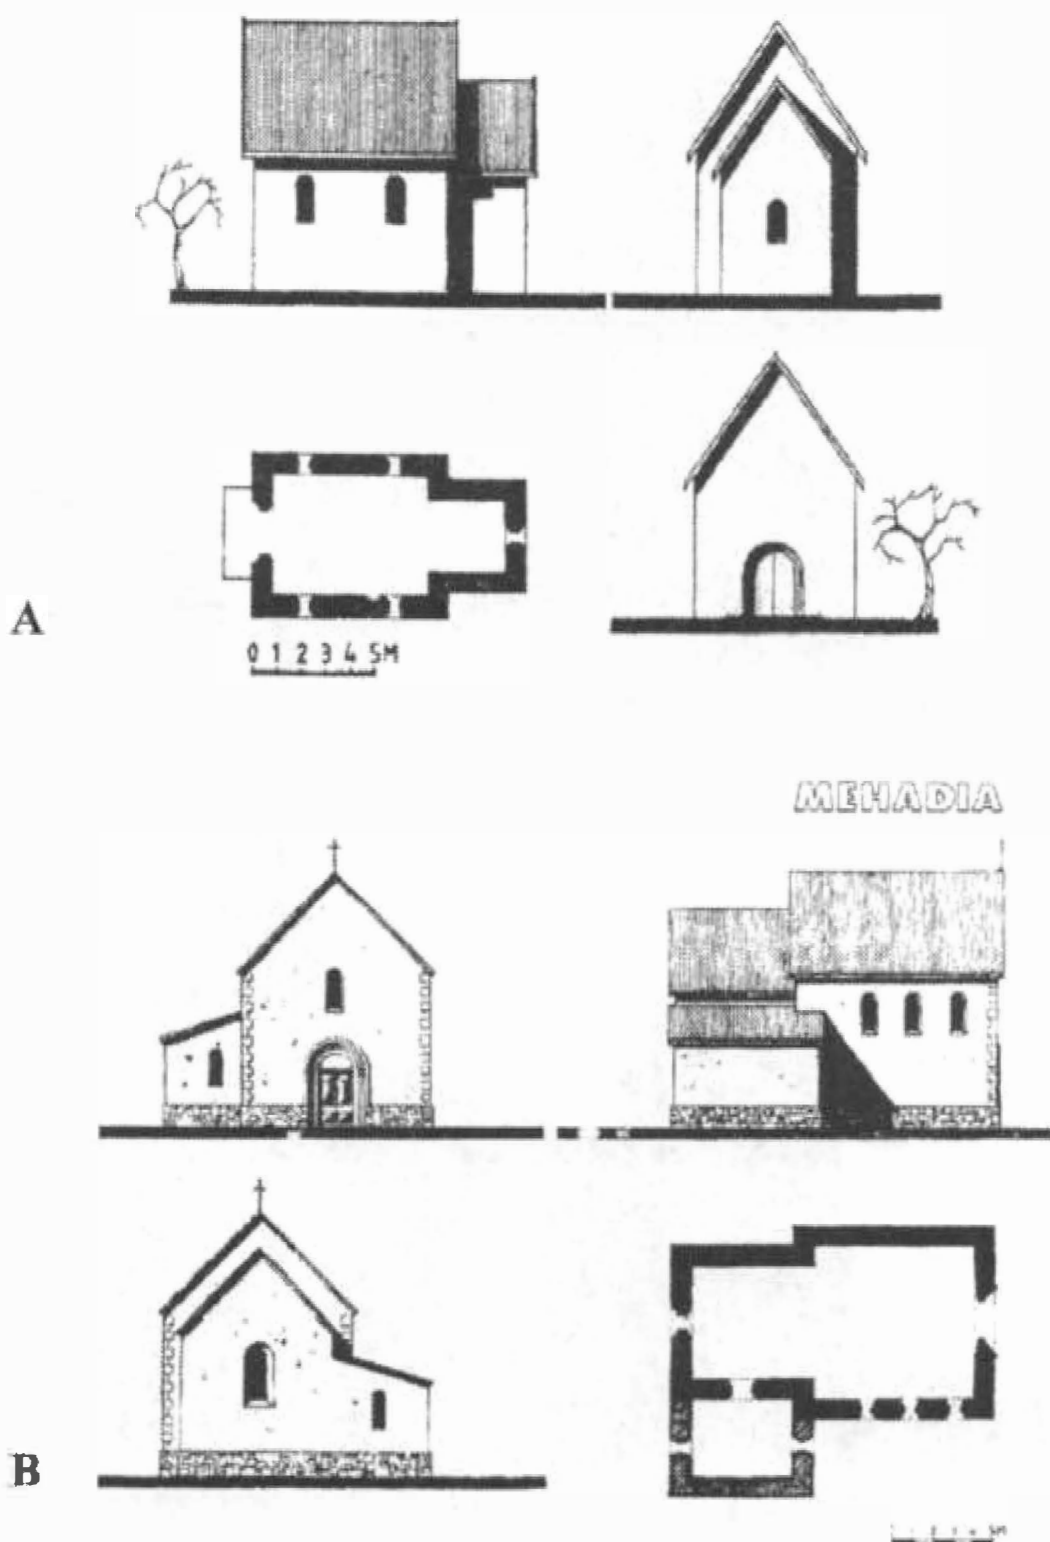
A. Reșița. Hofkapelle. Auf- und Grundriss (XIV Jh.);
